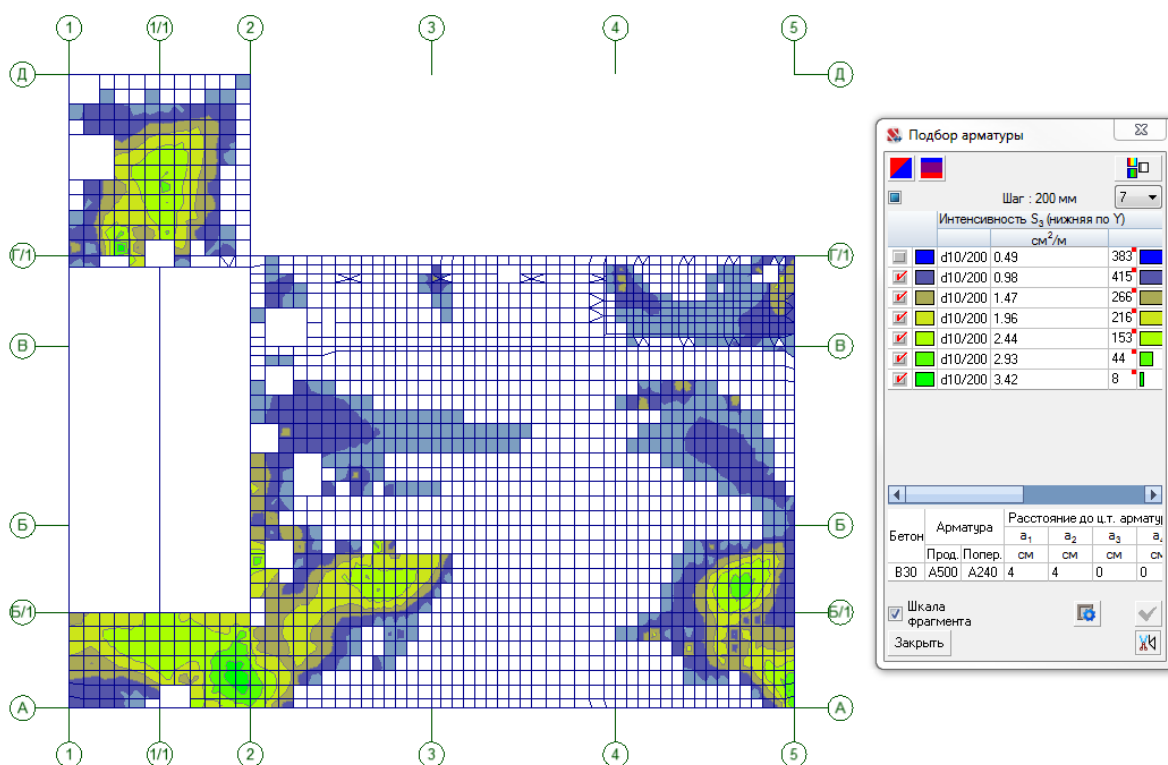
Нижнее армирование перекрытия резервуара по направлению Y (от оси А к оси Д)
